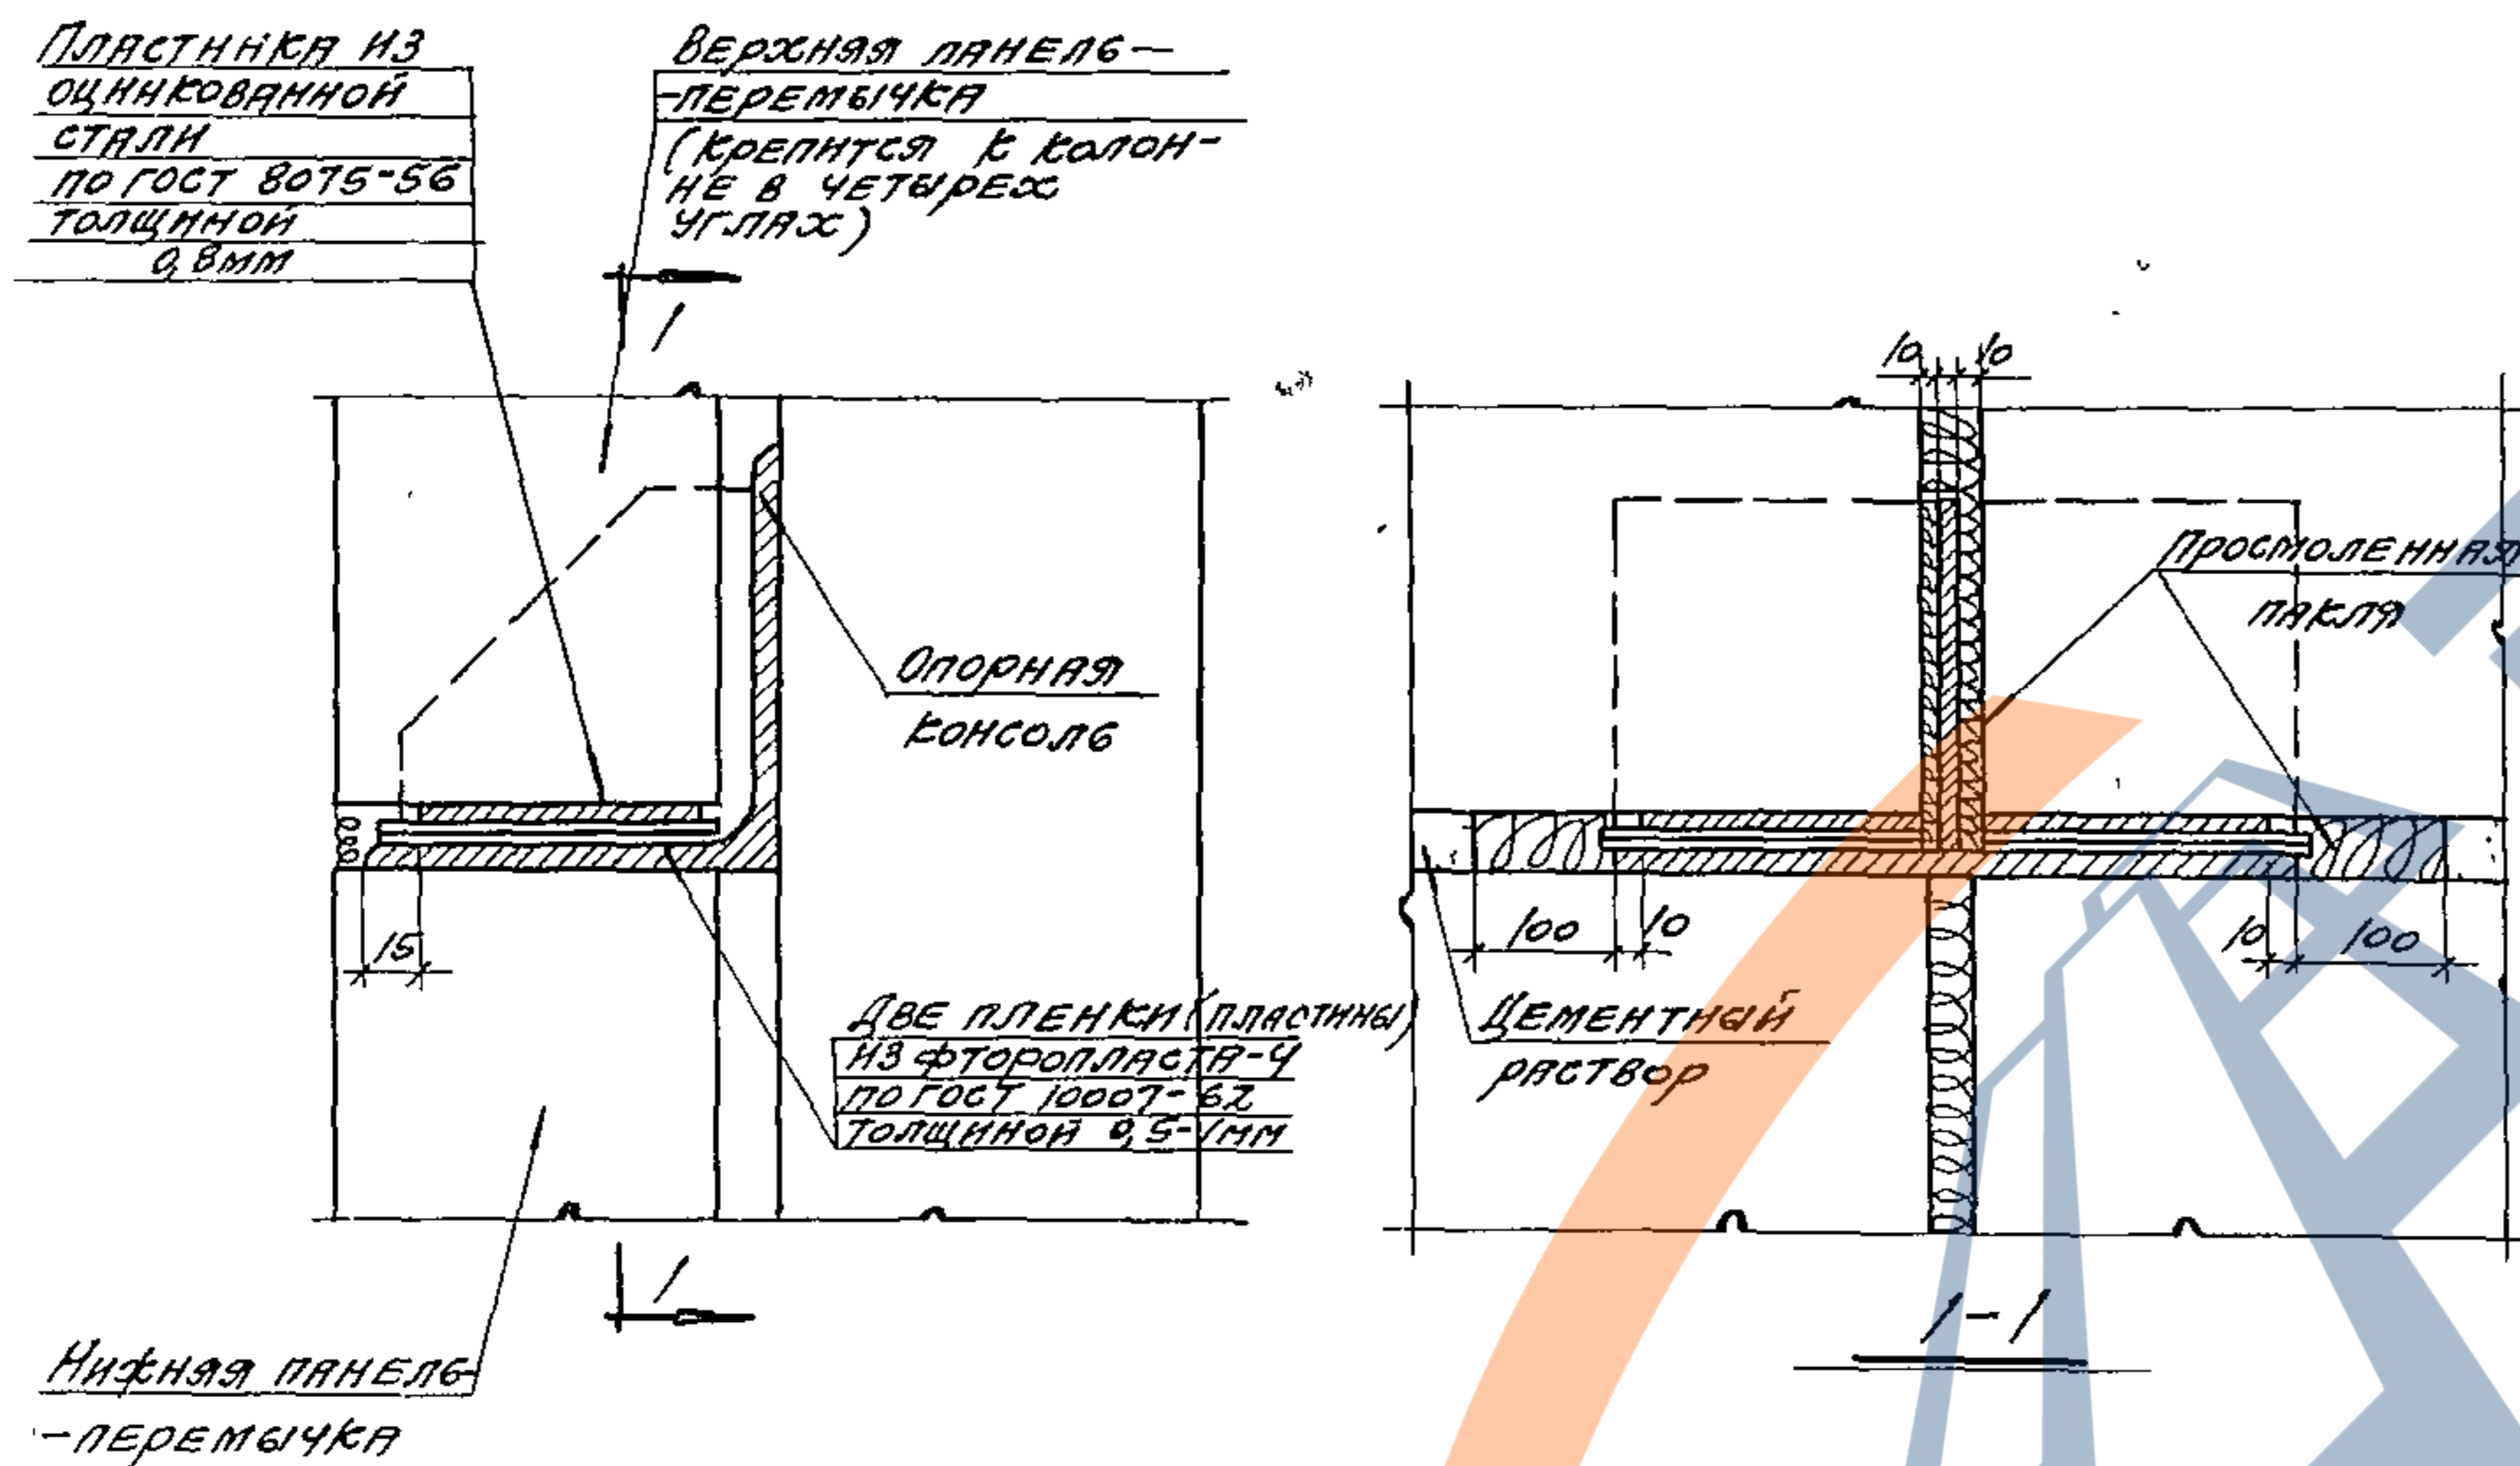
Температурный шов в продольных навесных панельных стенах на одной колонне (крепление панелей к колоннам условно не показано).
